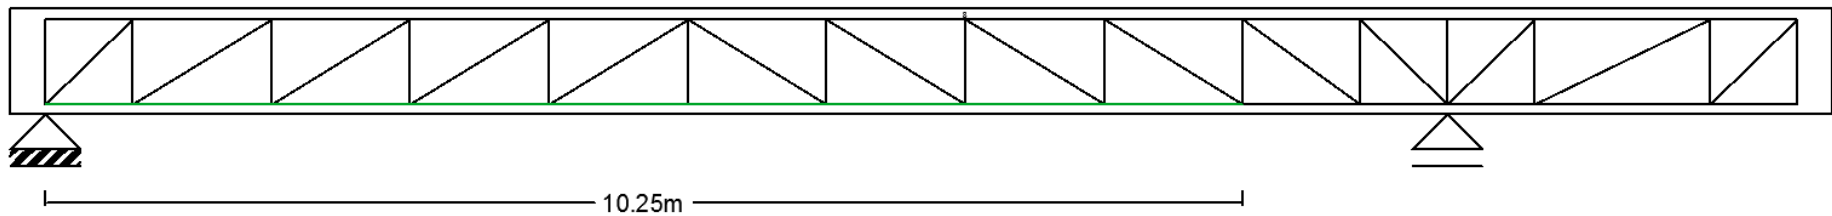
Traçado reto de pré-esforço adotado para a viga em estudo
